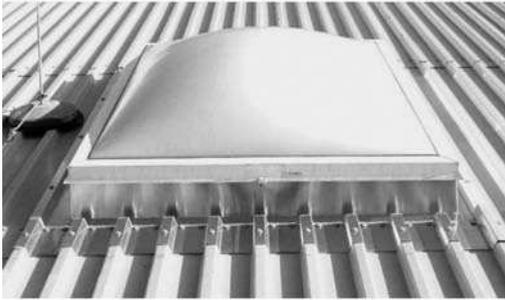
Auswechslung an einer Öffnung im zweischaligen Dachaufbau
